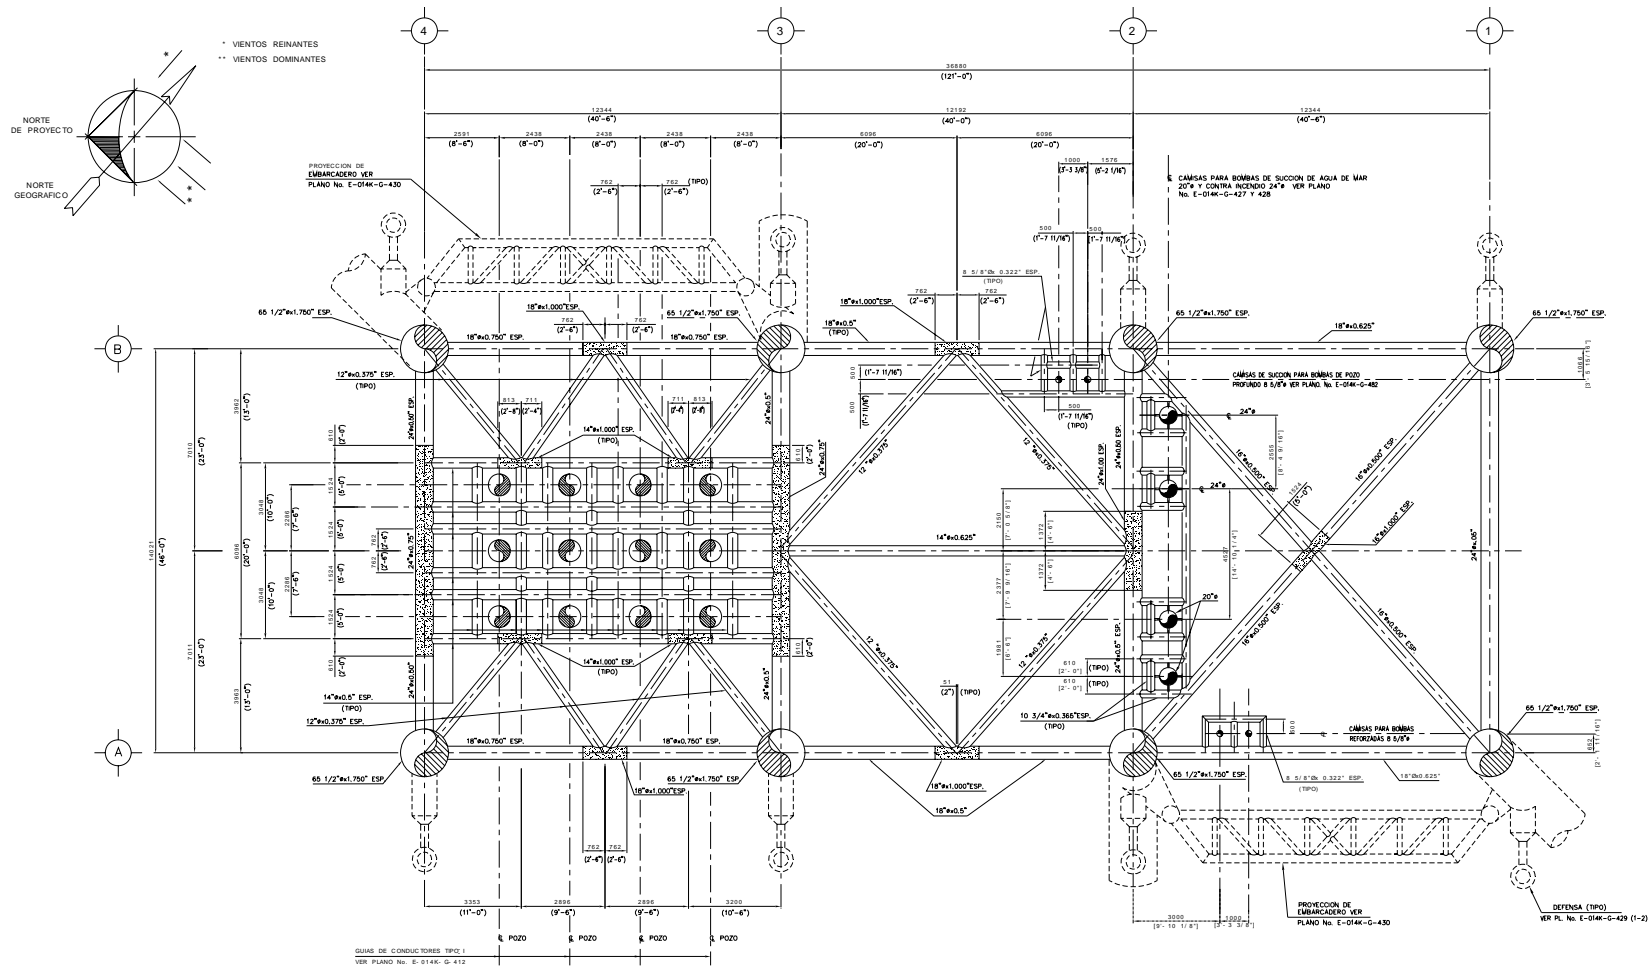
Planta en elevación (+) 9.350 m (30'-8 1/2").
